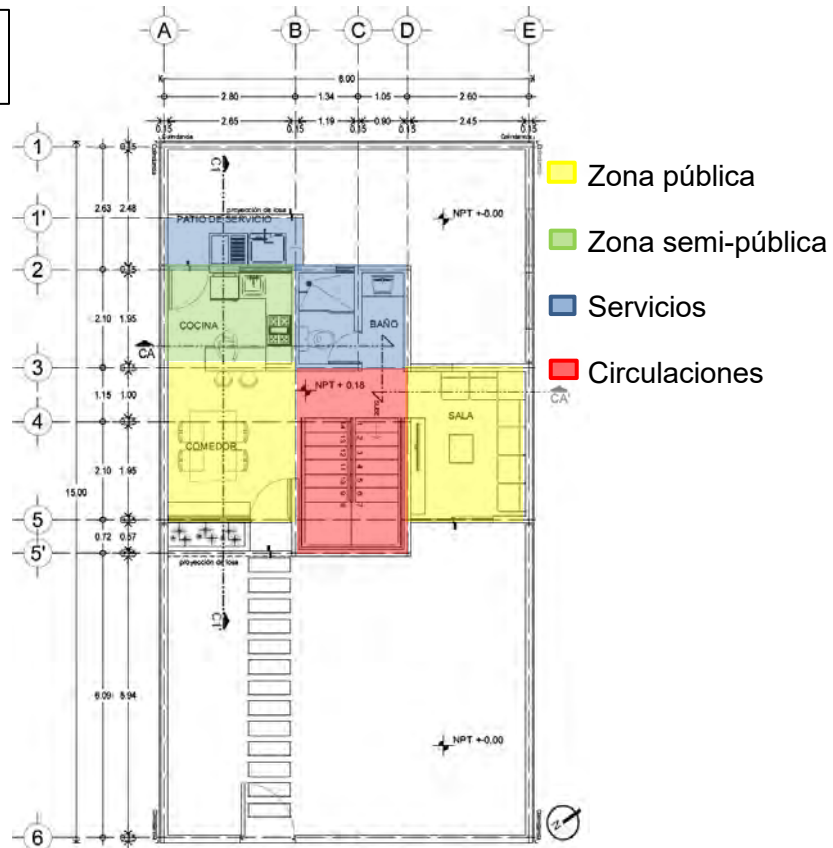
Planta arquitectónica de prototipo de vivienda A3. Segunda etapa, planta baja.
